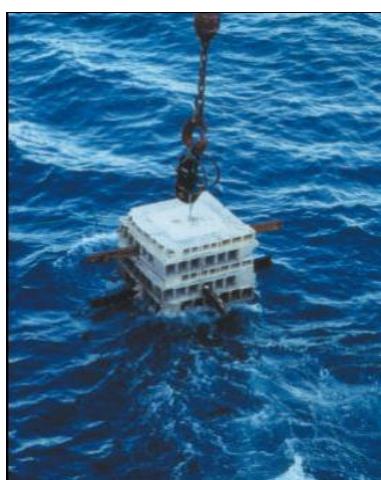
Las estructuras de producción o mixtas deben ser depositadas suavemente sobre el fondo.
